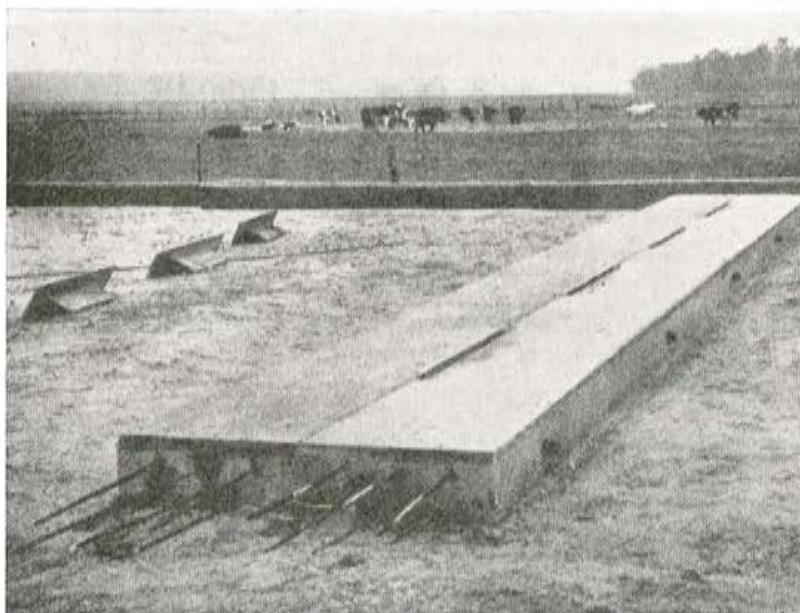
Vista de una junta activa, prefabricada *in situ*, antes de hormigonar las losas adyacentes.
